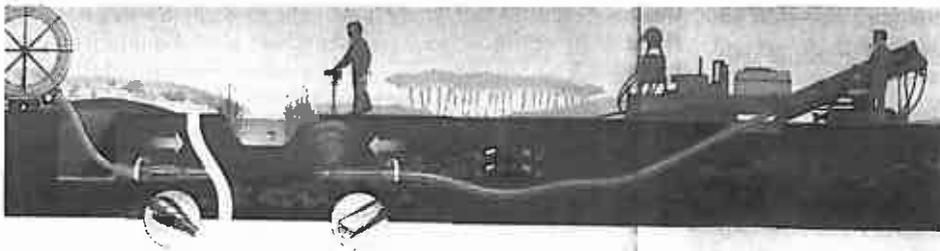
Prinzip der gesteuerten Horizontal-Spülbohrtechnik (Quelle Tracto-Technik)
